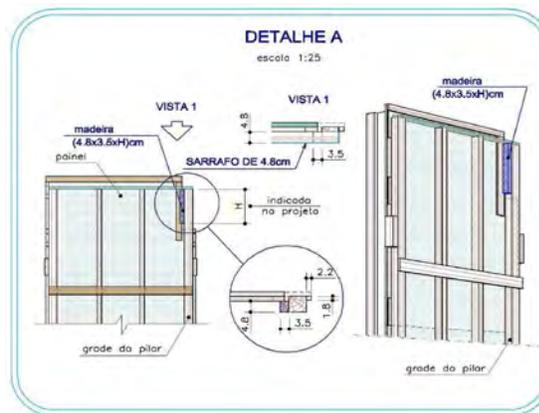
Detalhe para painel do pilar – Fonte: Projeto de Fôrmas (ASSAHI ENGENHARIA).
